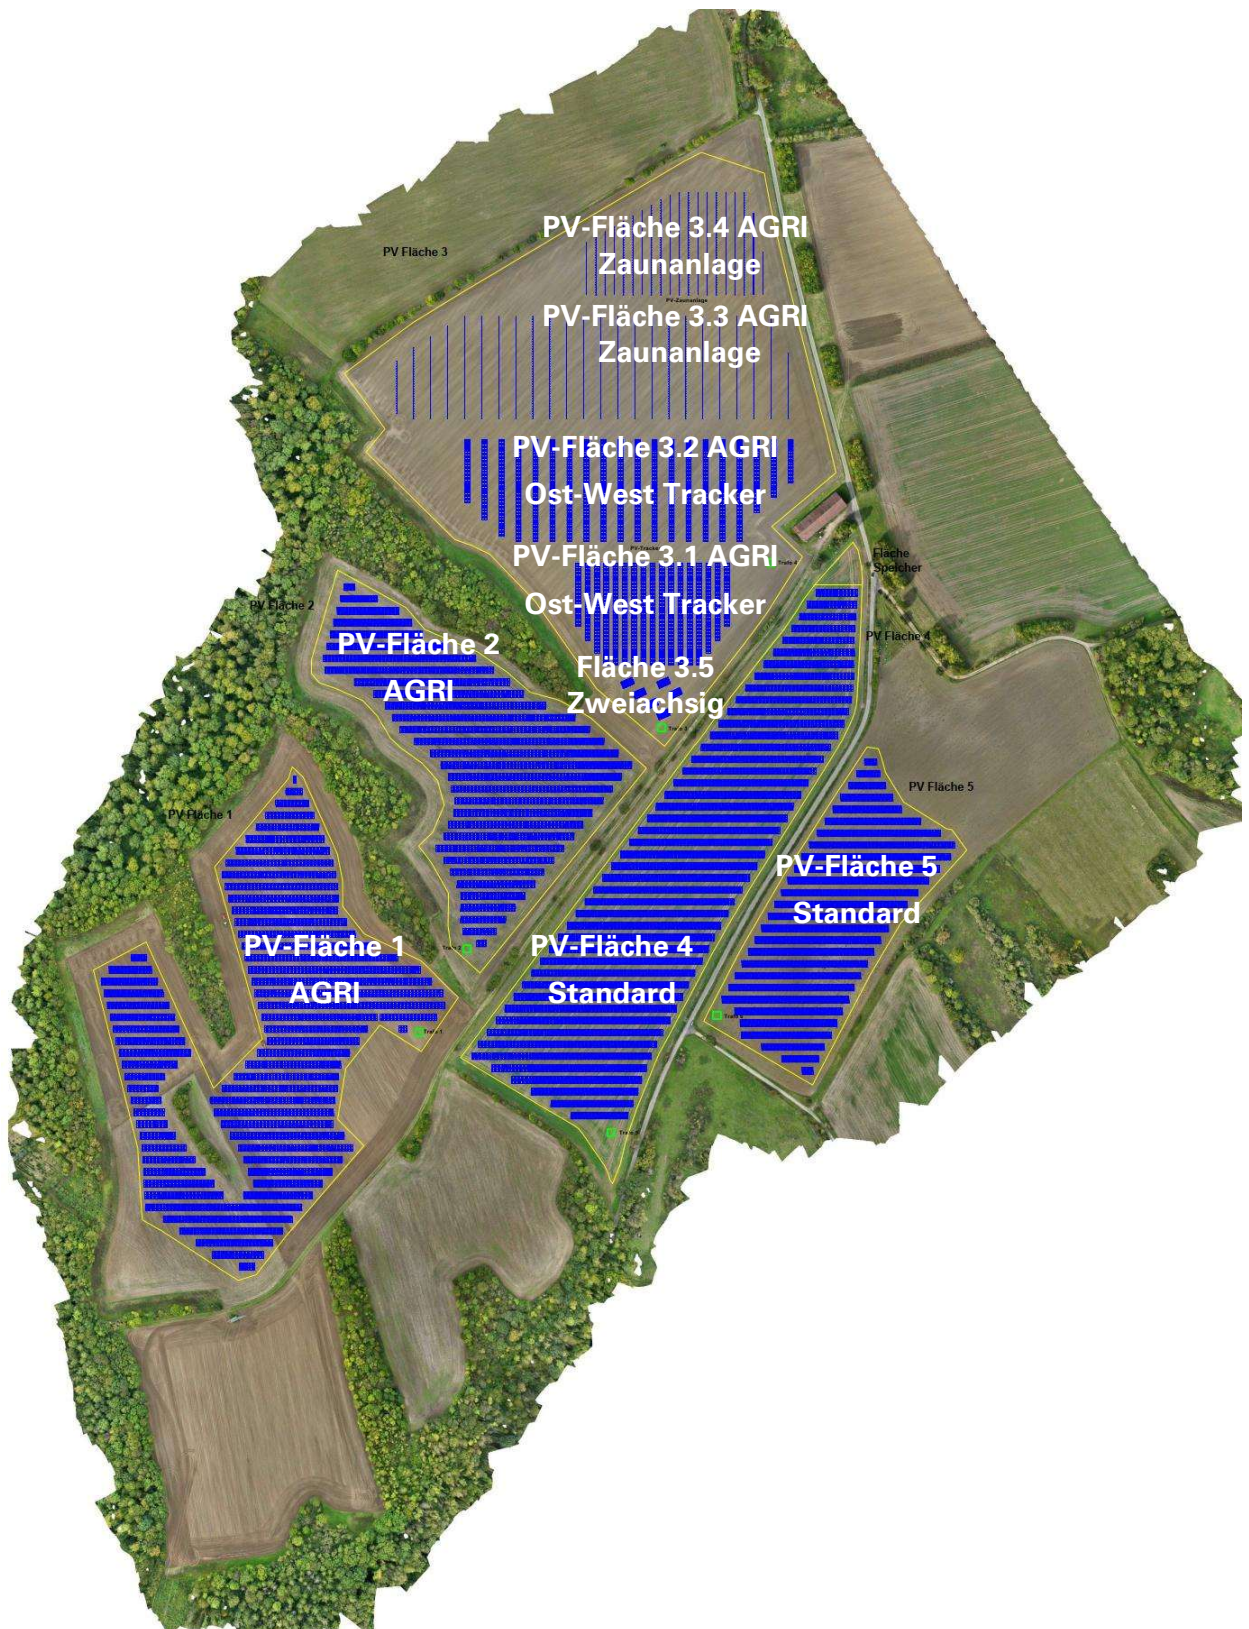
Aufstellungsplan zu den PV-Flächen gemäß Anlagenplanung
